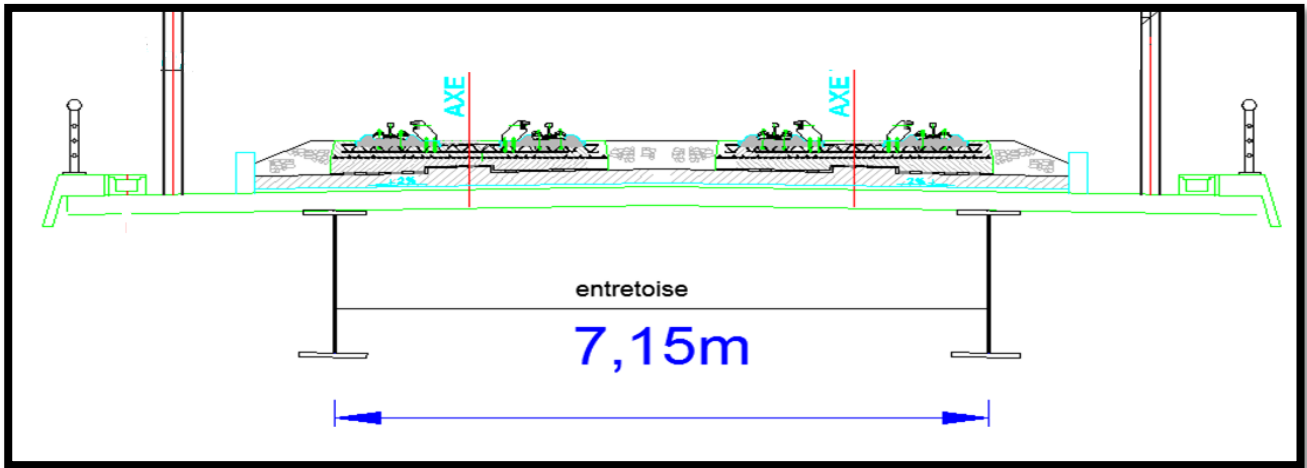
Coupe transversale au niveau d'appui (pont mixte).
